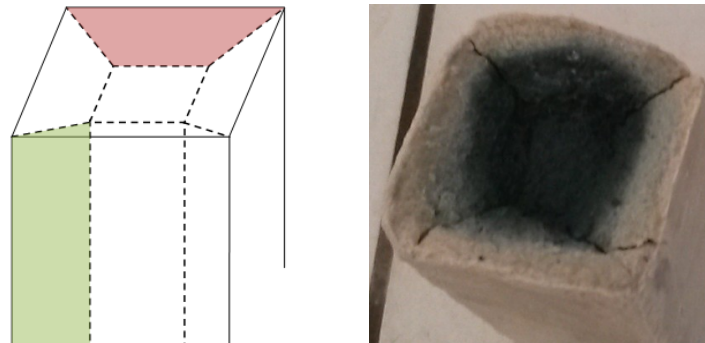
Plans de fissuration des éprouvettes parallélépipédiques.
